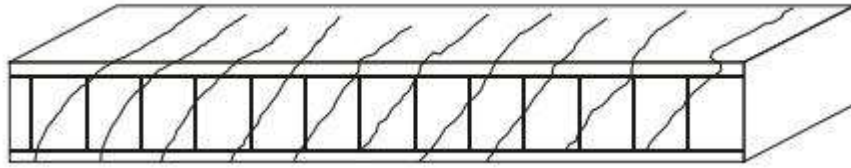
Exemplo de fissuras de cisalhamento em uma viga
